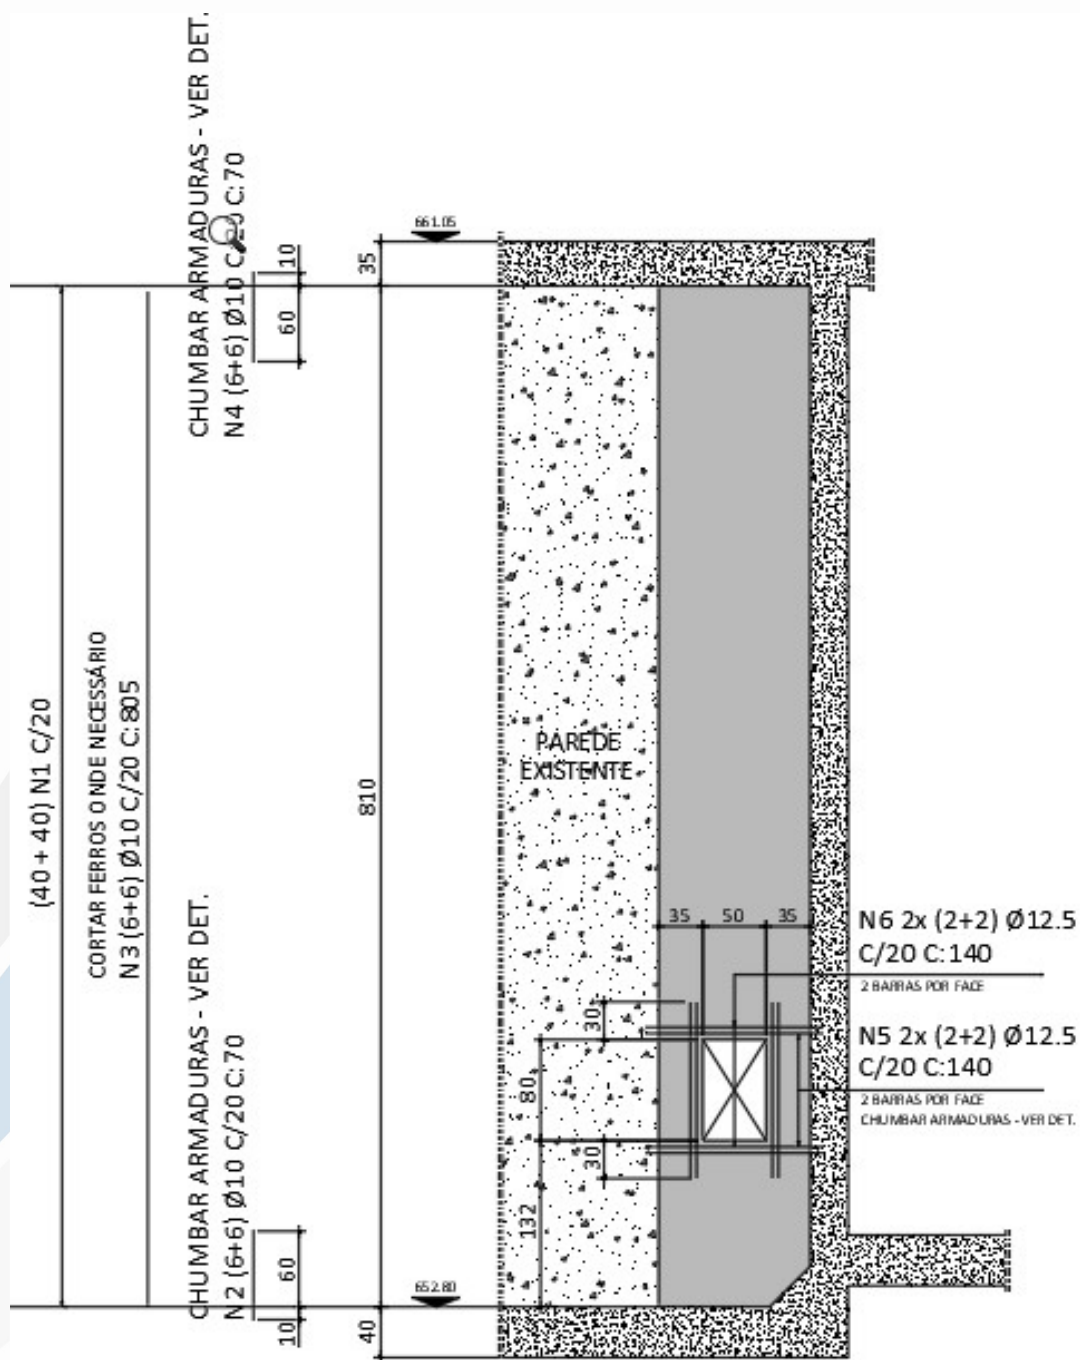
Detalhe em vista da PAR.01A a ser executada
